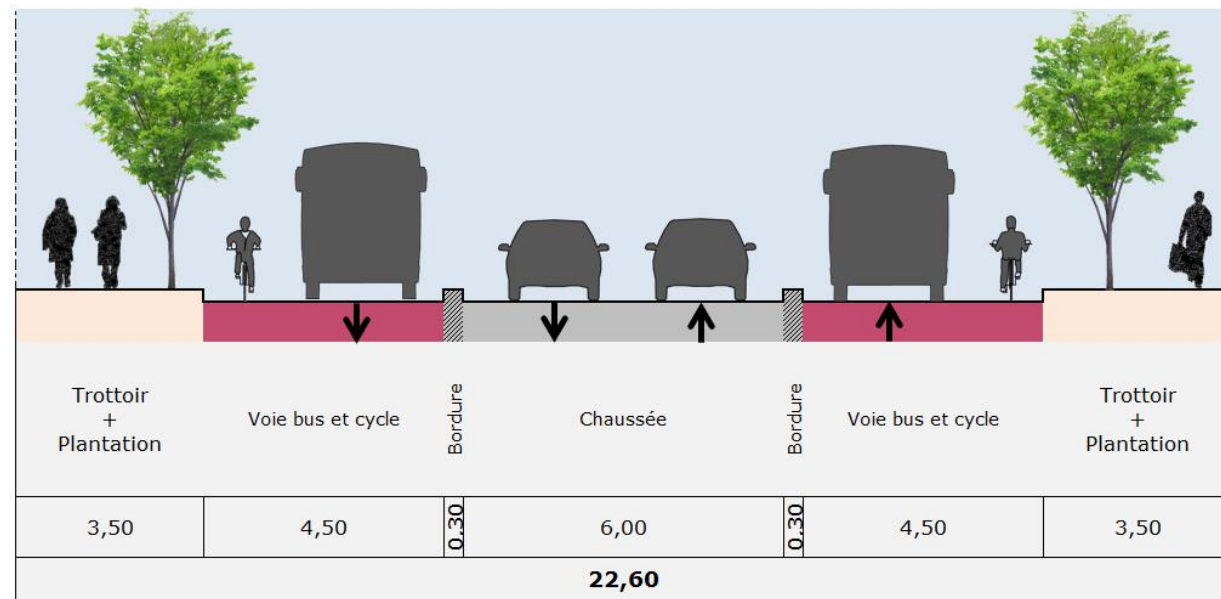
Coupe type pour l'insertion d'un site propre bilatéral
